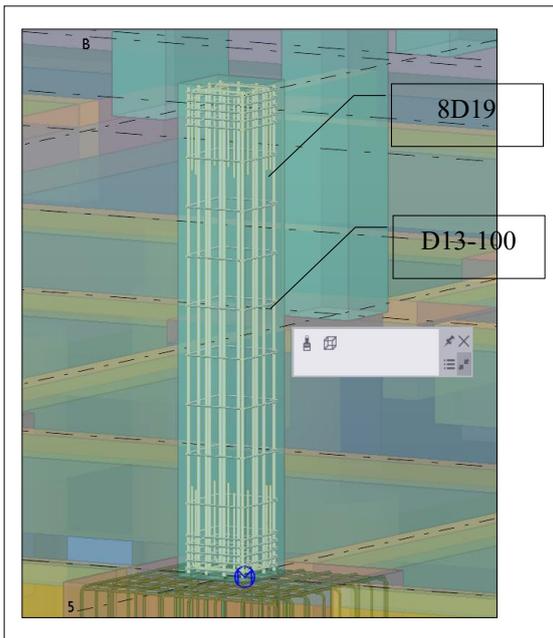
Detail Penulangan Pondasi Jasmine Park Apartment
